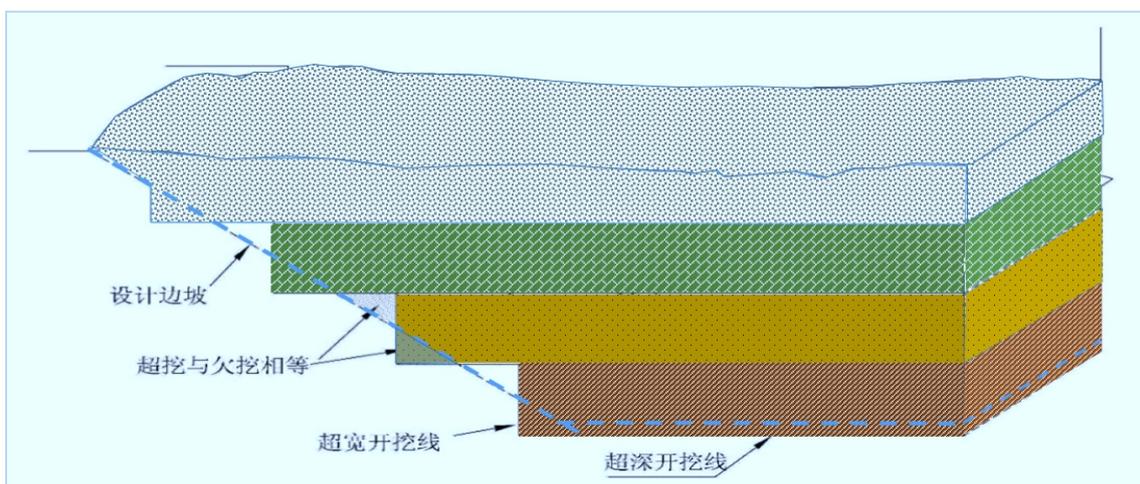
抓斗挖泥船边坡分层施工示意图
